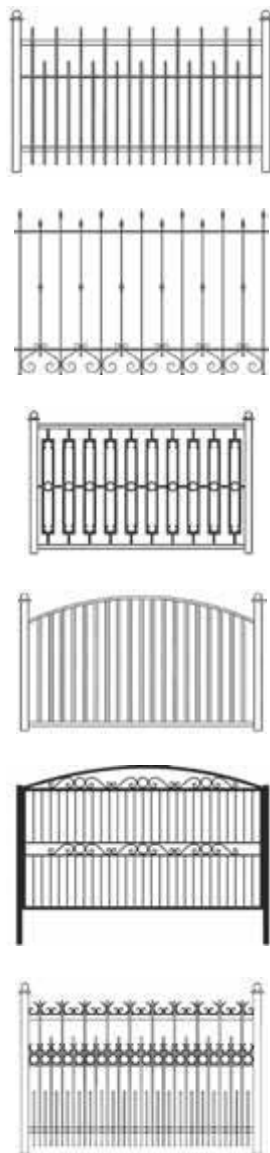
Внешний вид секций наиболее распространенных металлических сварных заборов
